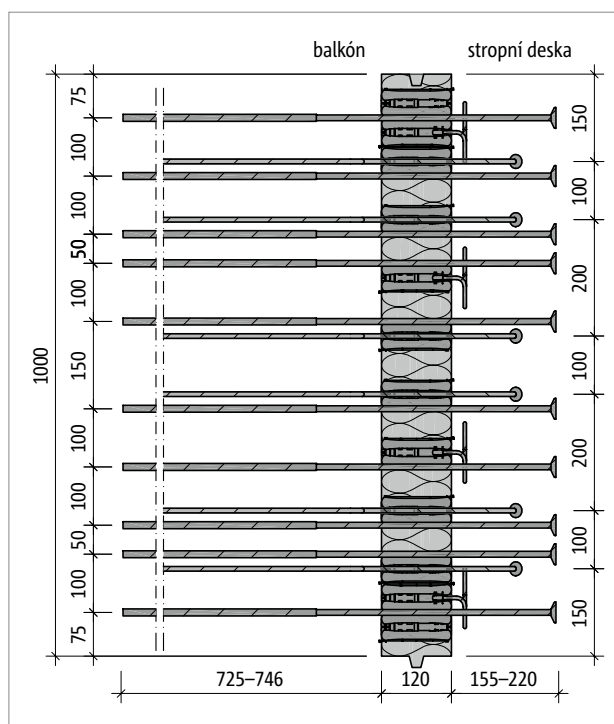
Schöck Isokorb® XT typ K-U-M2: Řez prvkem
